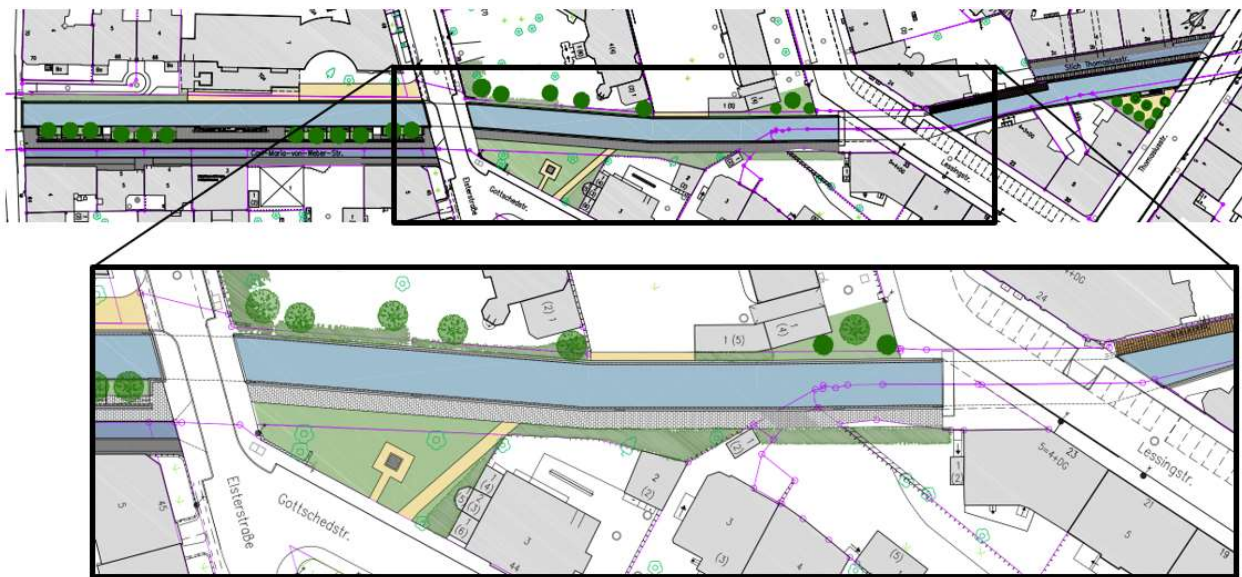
Übersichtslageplan TBA 3.2 – planfestgestellte Planung
